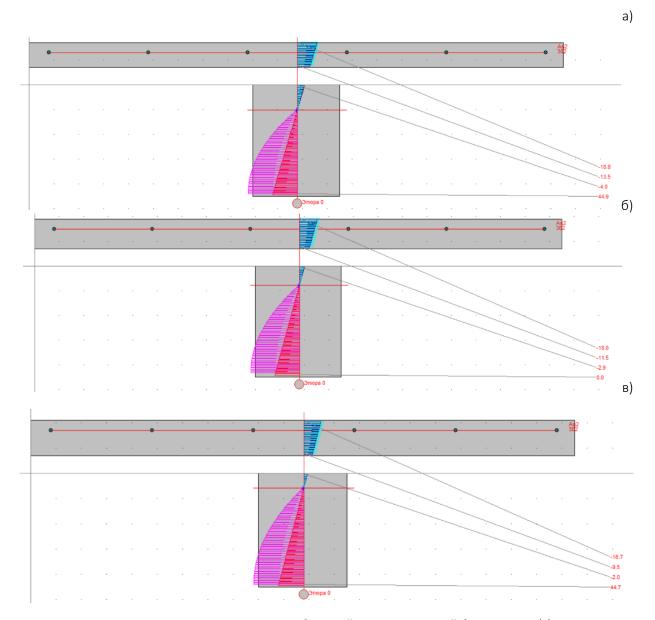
Поперечное сечение деревобетонной плиты с толщиной бетона 50 мм (a) с толщиной бетона 60 мм (б) с толщиной бетона 70мм (в)
